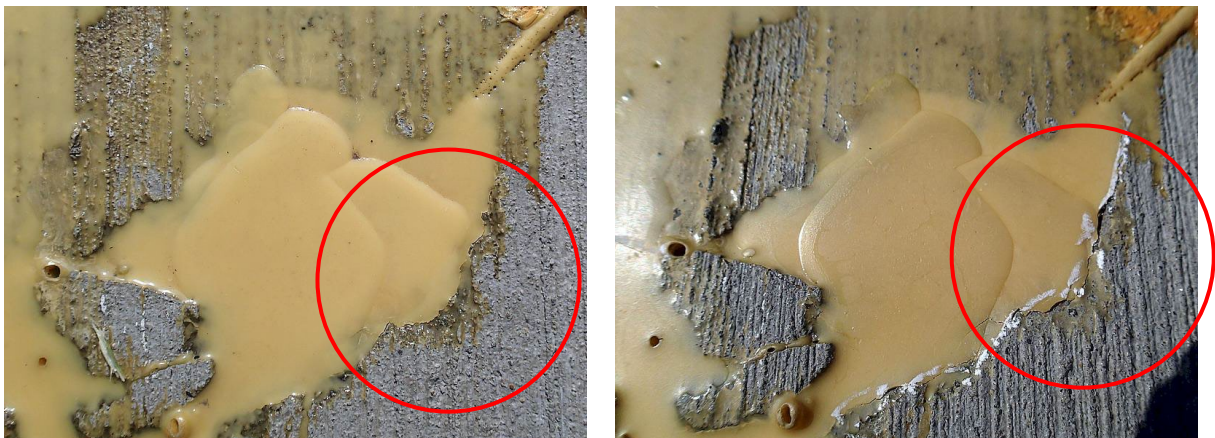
模擬亀甲ひび割れ箇所の外観変状（けい砂無し）
